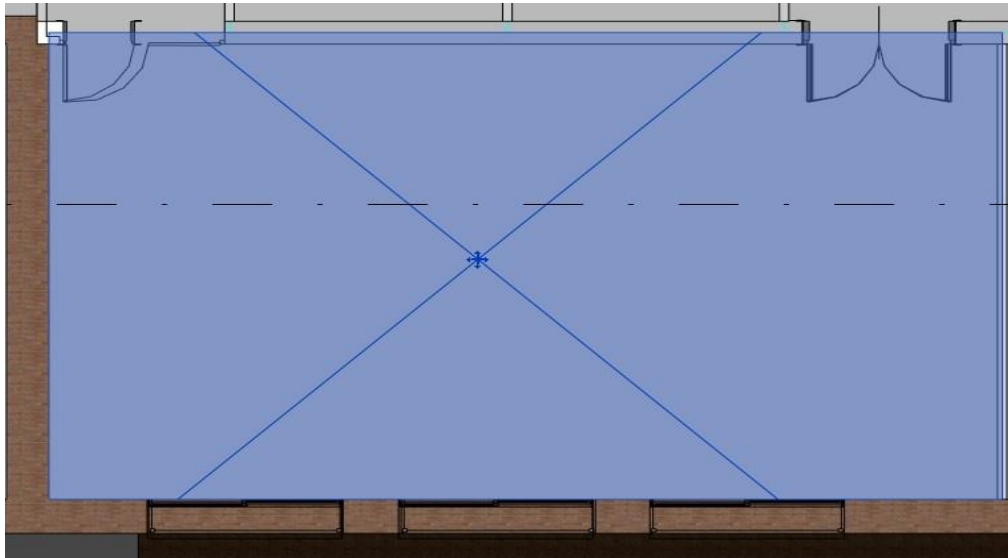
Vista en planta de l'habitació al aplicar "Separador habitació"
